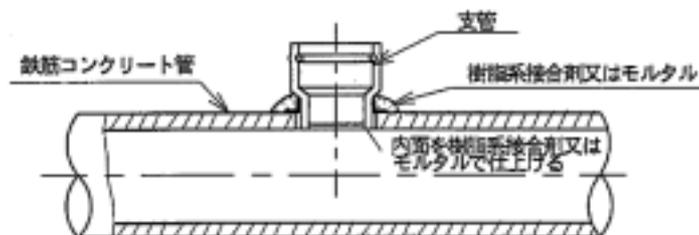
鉄筋コンクリート本管に対する支管の接合
